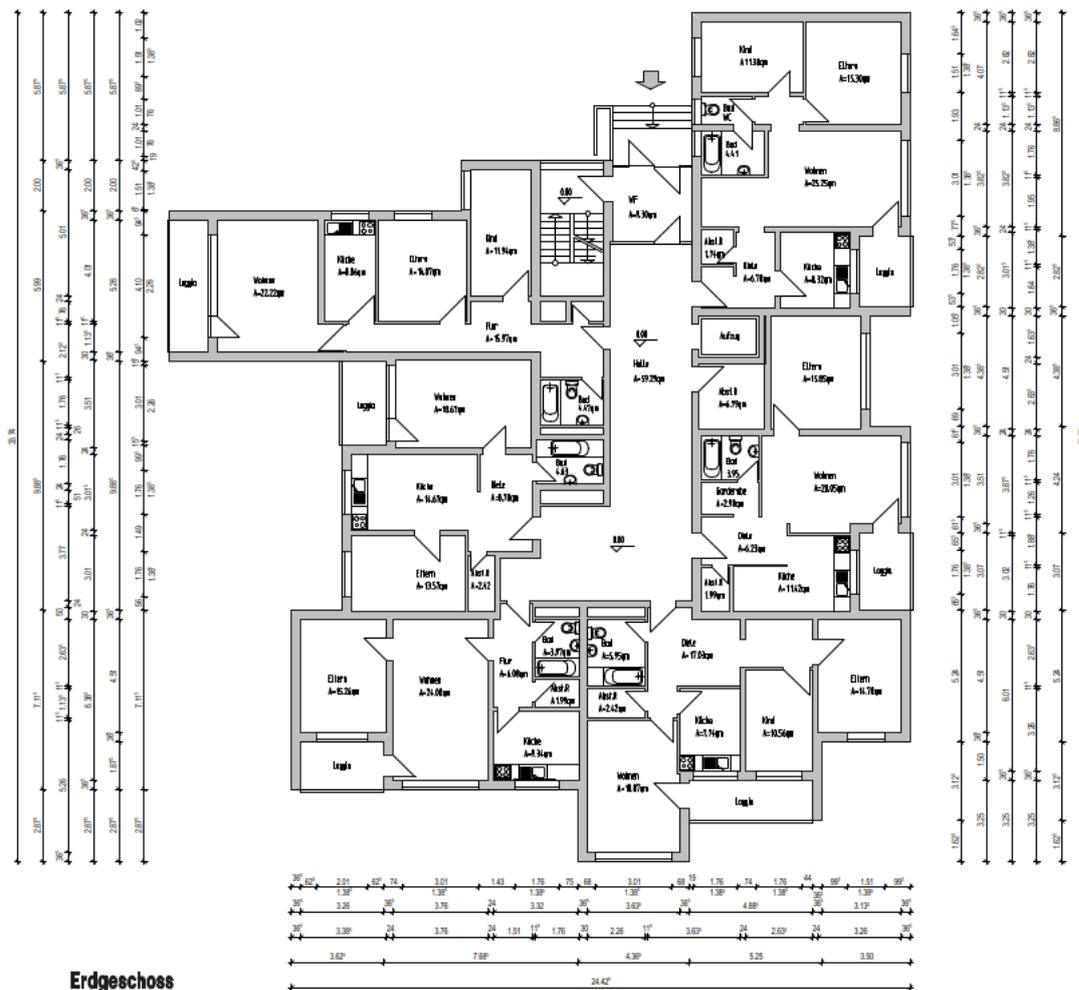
Grundriss Erdgeschoss
